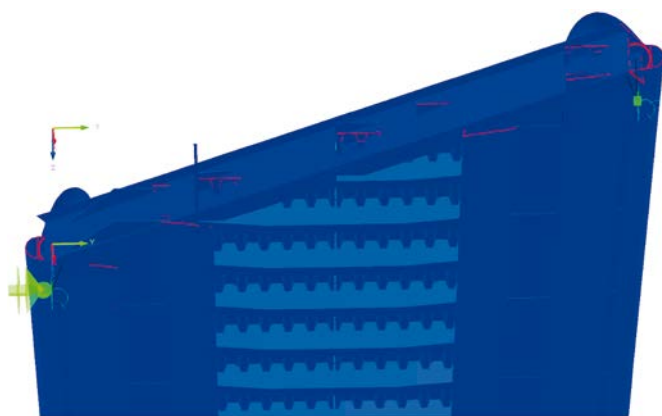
Brückenuntersicht räumliches Stabwerksmodell
